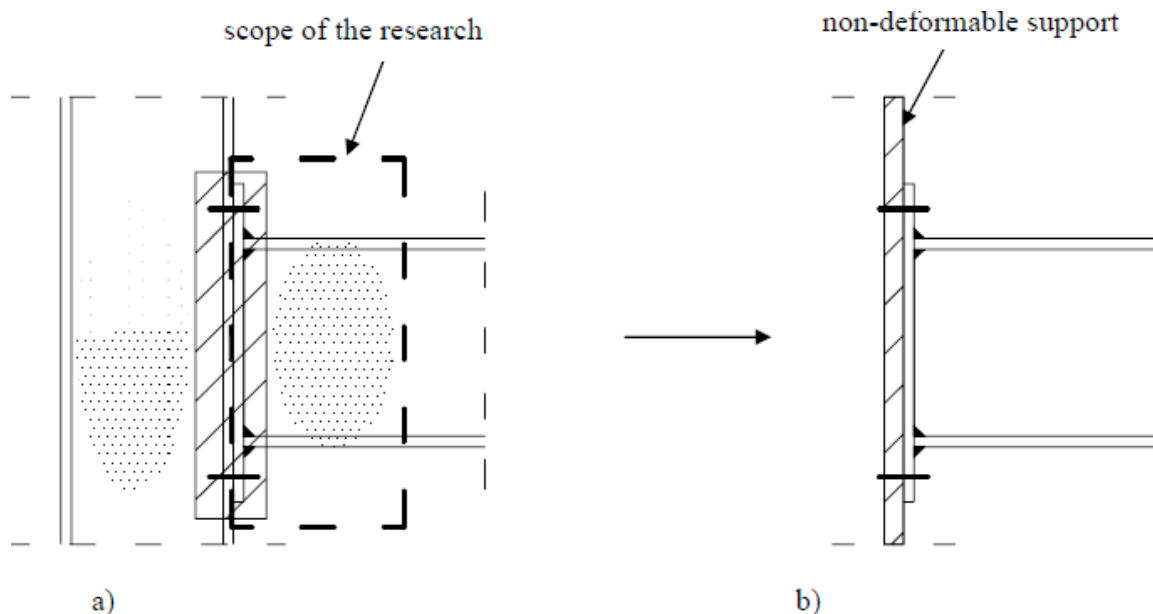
a) Ligação coluna-viga [3]; b) Modelo da ligação estudada por Nauzika [3].
